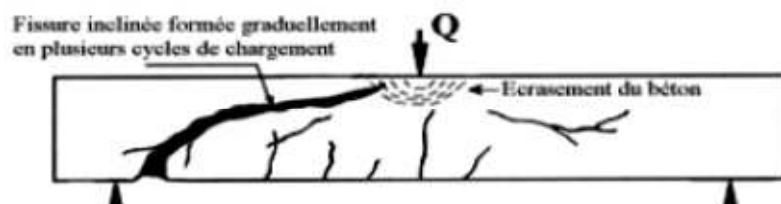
Schéma typique d'une poutre en BA endommagée par la compression due au cisaillement.
